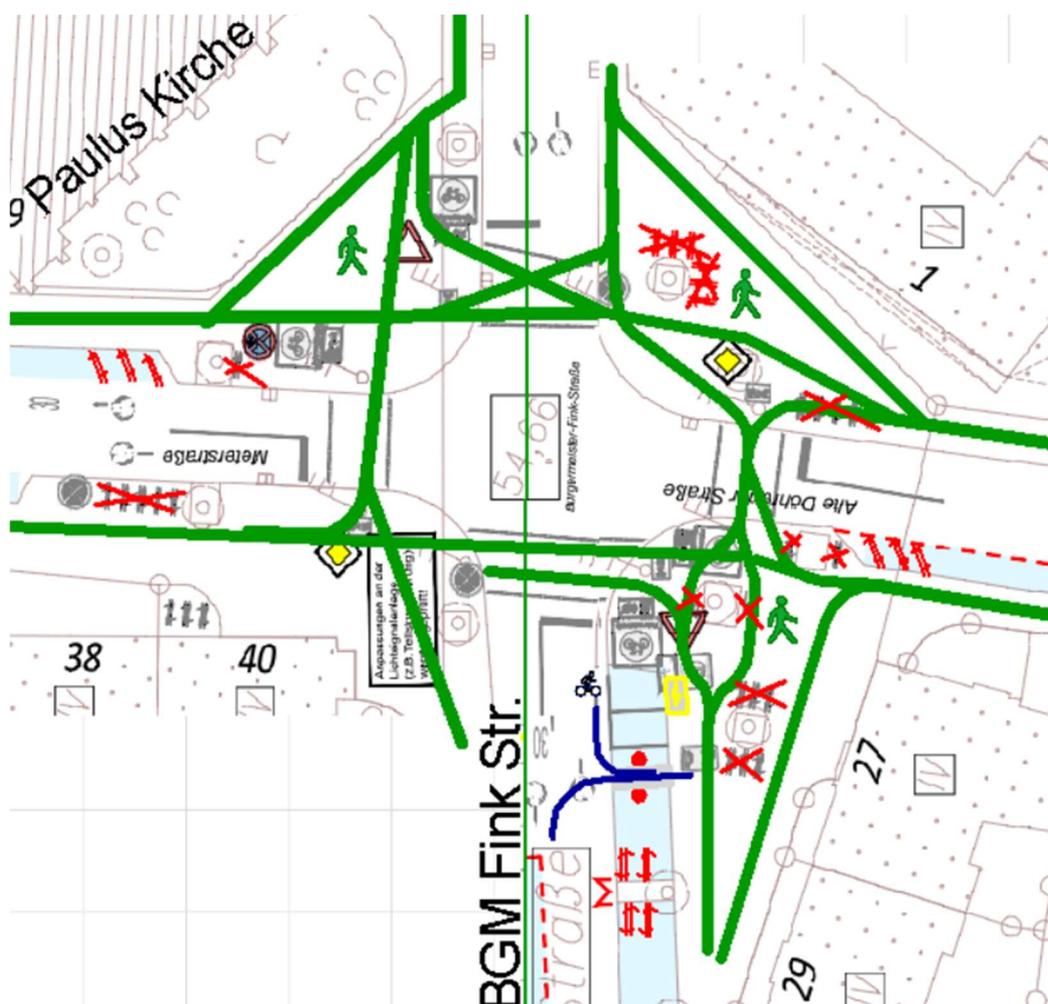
Kreuzung Alte Döhrener Straße mit der BGM-Fink-Straße. Detail aus Bild 32.
